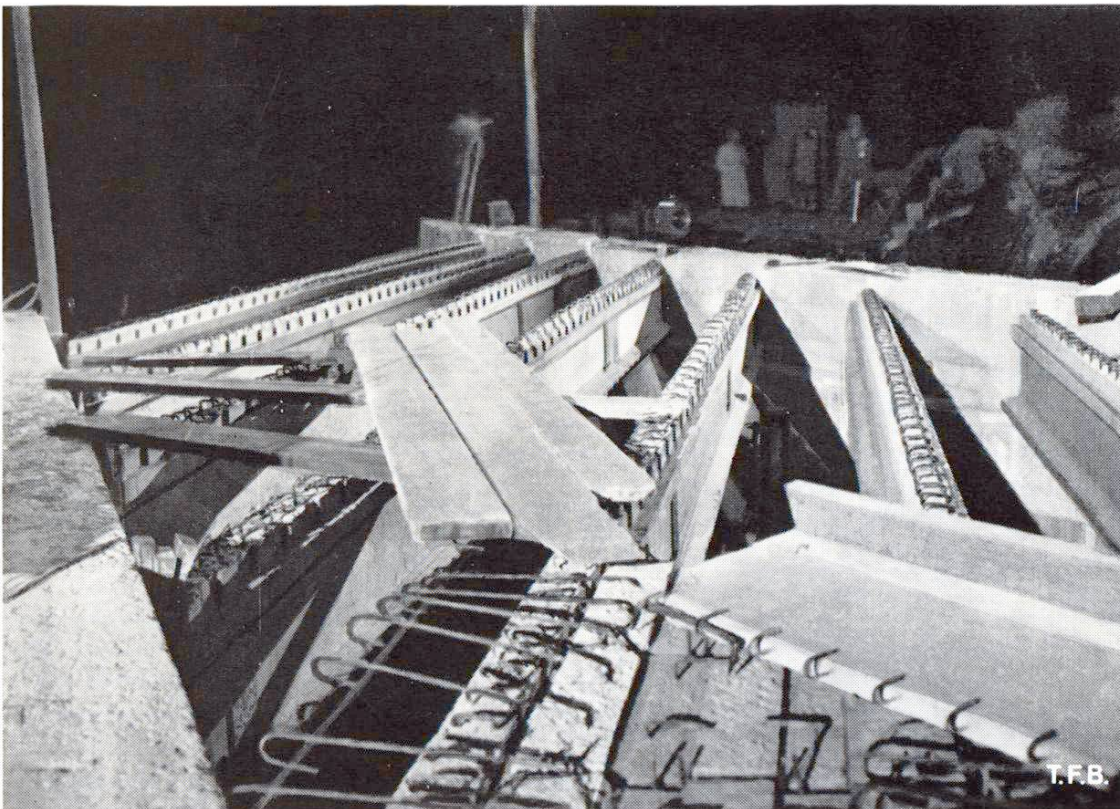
Mise en place nocturne des poutres préfabriquées en béton précontraint d'un pont de l'Axenstrasse
